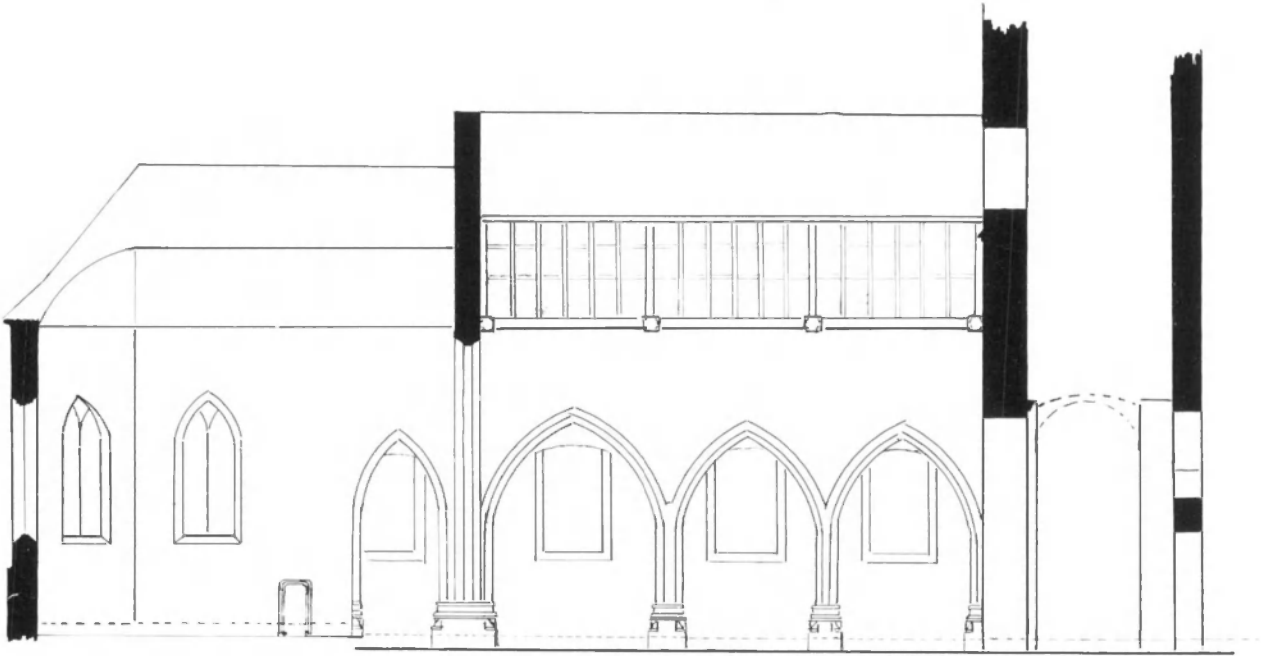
BLAUGIES, église Saint-Aubin, coupe longitudinale (en pointillé, niveau du pavement actuel; en trait plein, niveau du pavement du XVI^e siècle).
